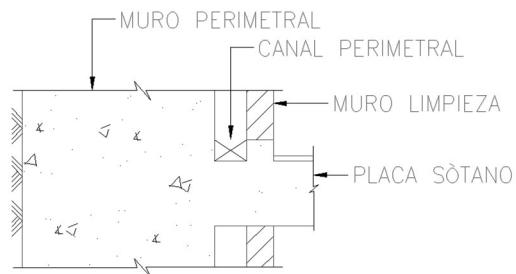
Detalle canal interno sobre placas de sótano (archivo propio)
